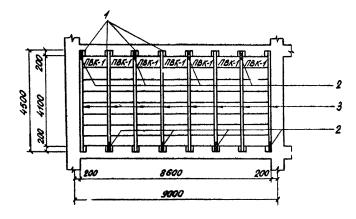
План участка перекрытия из балок ОБТ-430 с опиранием на протезы ПР-1 и мехбалочным заполнением из плит ПВК-1:
